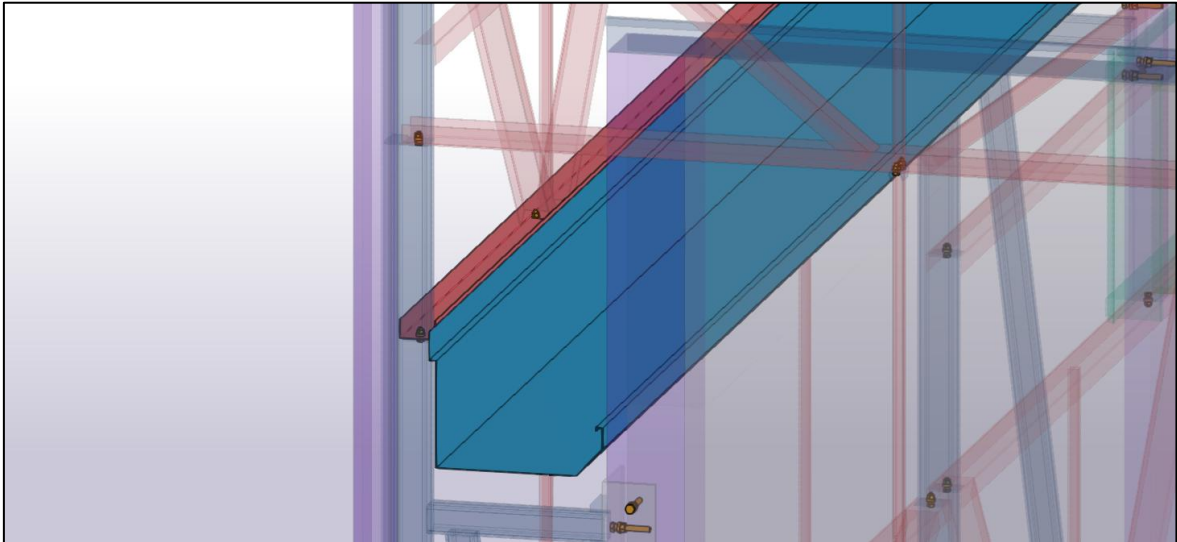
Caleira dimensionada e fixada entre a parede de alvenaria e a madre de fachada (Autor/Tekla Structures)
